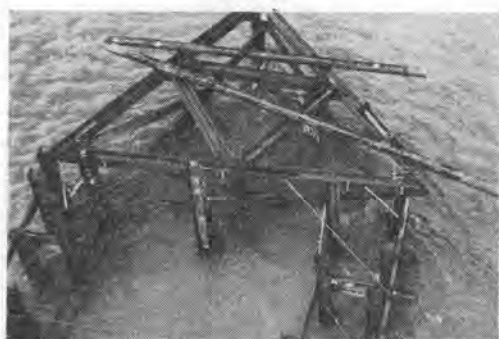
基礎ぐいを打ち終わった状況でフレームを取付け中
